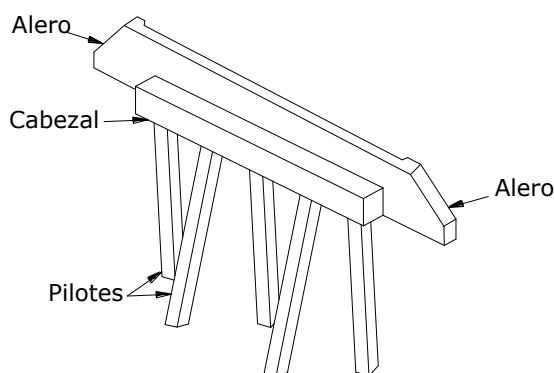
Estribo de caballete sobre pilotes con aleros cortos
